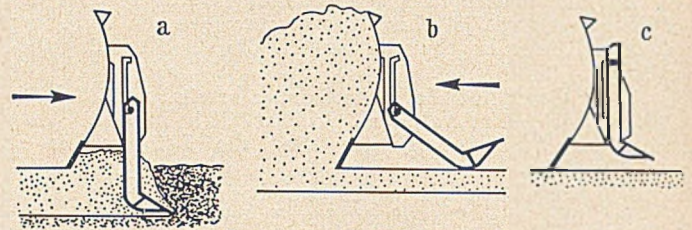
Aufreißer-Vorrichtung (Back-rip Scarifiers) als Zusatzgerät zur Planiererraupe, wirkt nur bei Rückfahrt der Planiererraupe. — a) Rückwärtsfahrt der Planiererraupe — Aufreißerzähne arbeiten. — b) Vorwärtsfahrt der Planiererraupe — Aufreißerzähne schleifen hinter dem Planierschild her. — c) Aufreißerzähne außer Betrieb.
